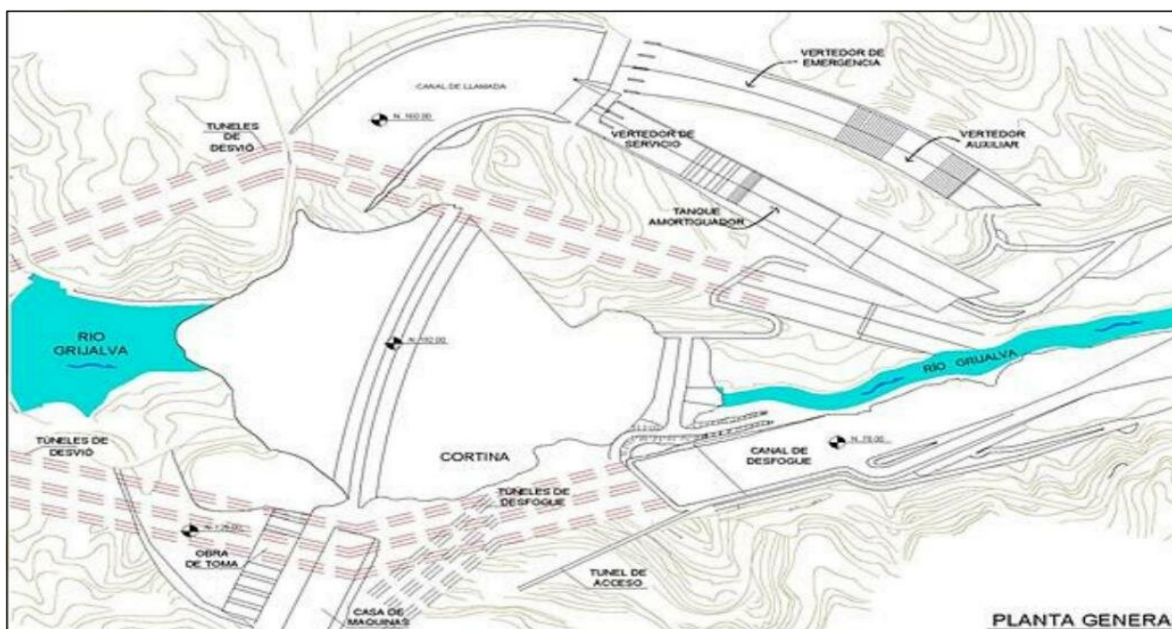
Planta general de la presa “Nezahualcóyotl”. Fuente: CFE
